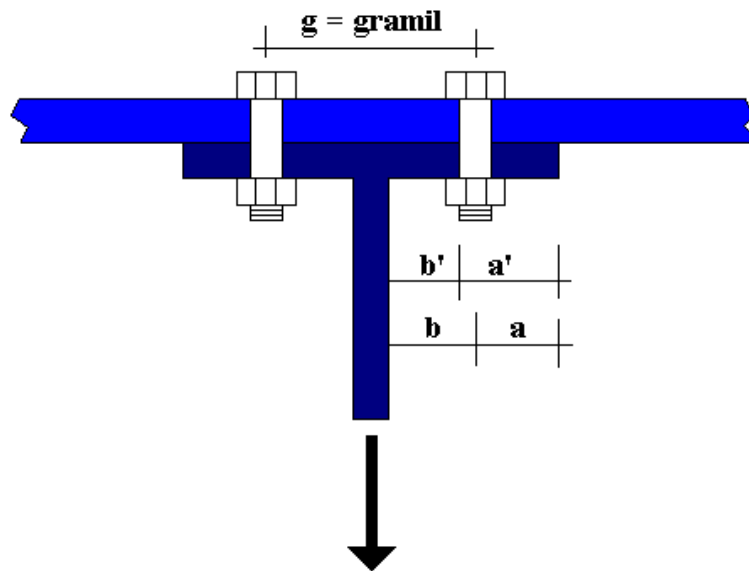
Definición de constantes para el cálculo de la acción separadora (Ref. 3)
